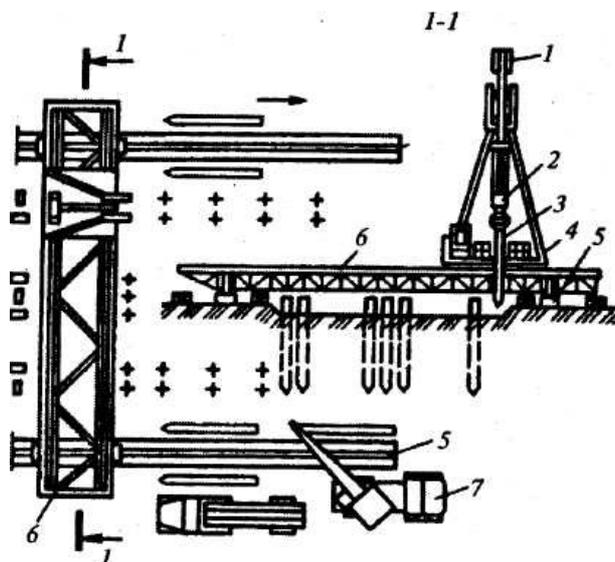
Схема погружения свай мостовой сваебойной установкой:
